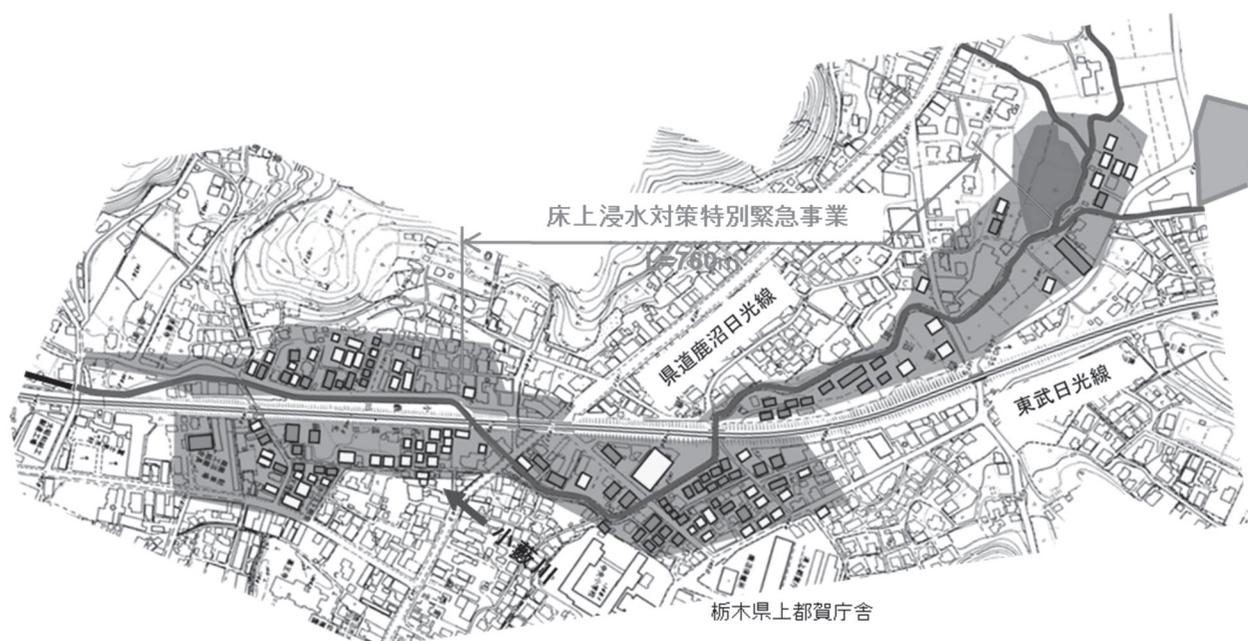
床上浸水対策特別緊急事業 平面図 (小藪川)
